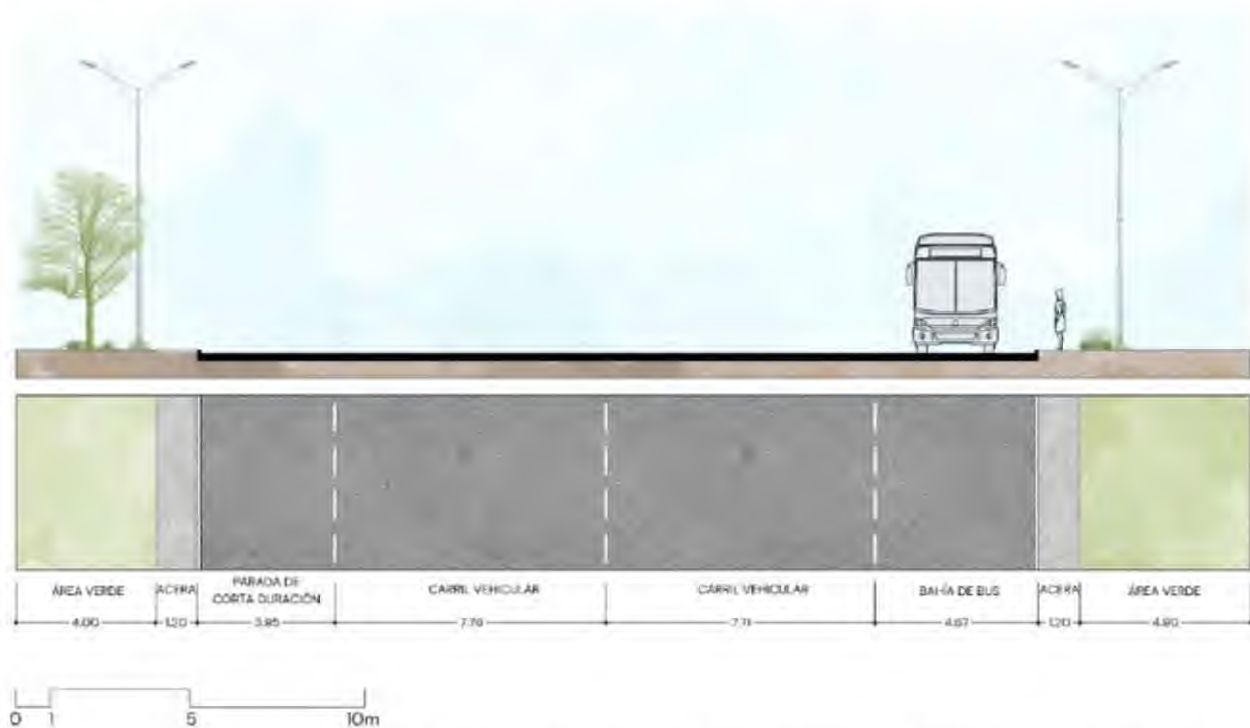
Sección vial de bahía de bus y parada de corta duración. Fuente: Autoría propia.
